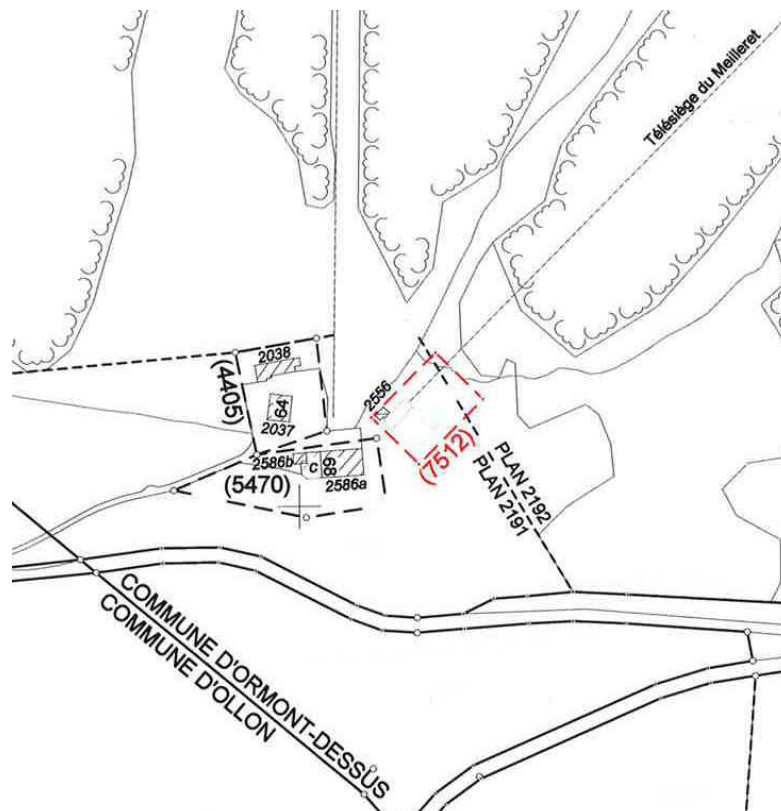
Plan de situation avec le droit DDP (7512) de 2453 m<sup>2</sup> prévu en faveur de TVGD
